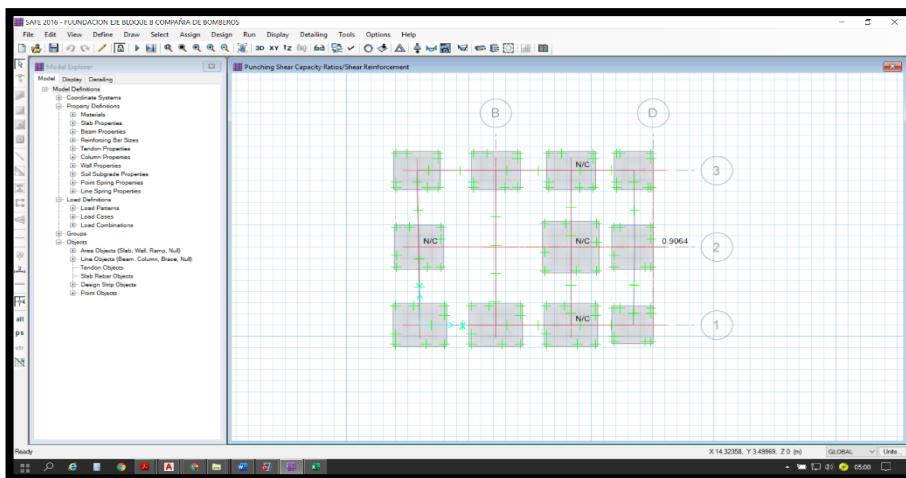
Bloque A - Verificación del punzonado de las zapatas de la sub estructura.
